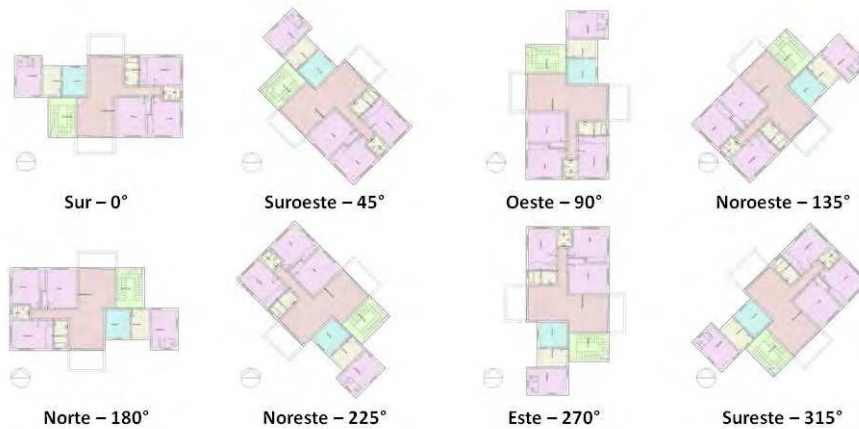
Planos de distribución del MR-multiplanta según la orientación.
